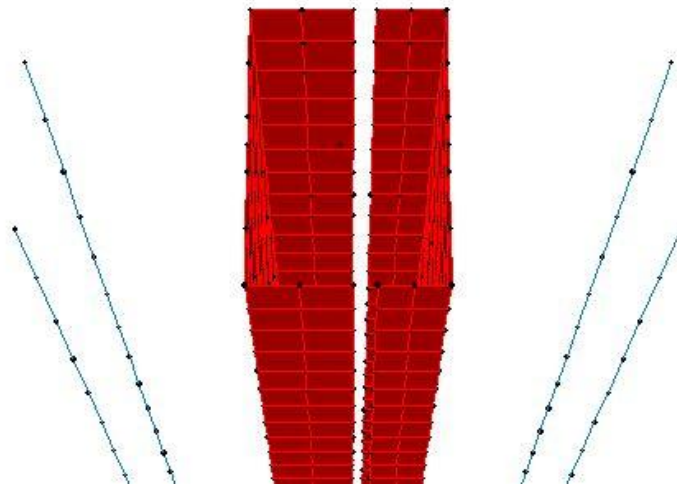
Vista em planta, a partir do 37º piso, do núcleo central com aberturas e dos pilares laterais
